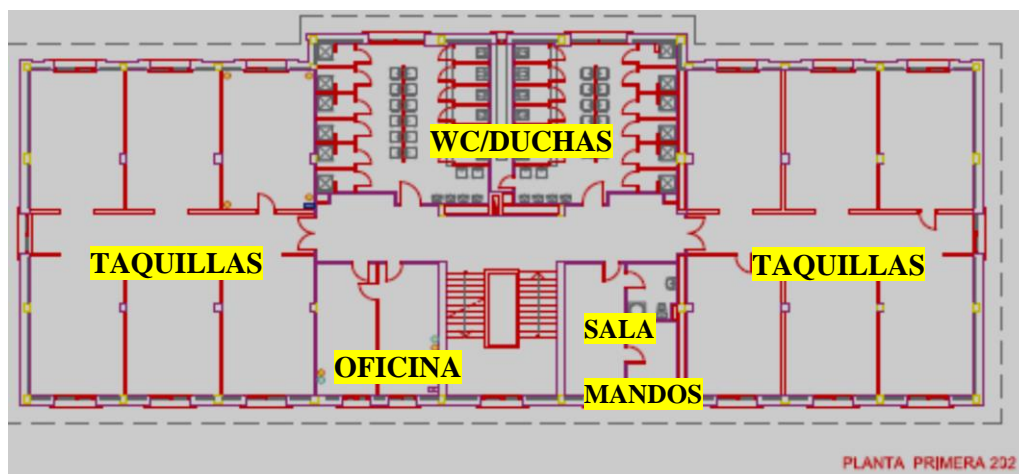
Planta edificio 202 primer piso. Fuente: Plan de mantenimiento 19-20
